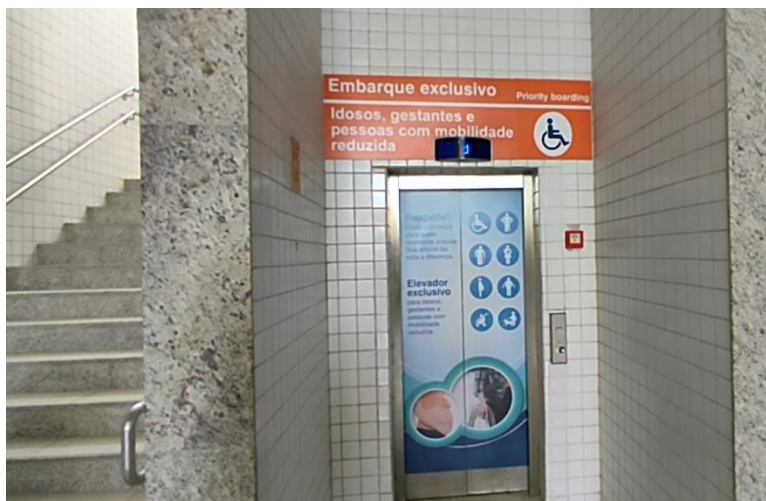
Escada fixa e Elevador – ausência de elementos de acessibilidade
